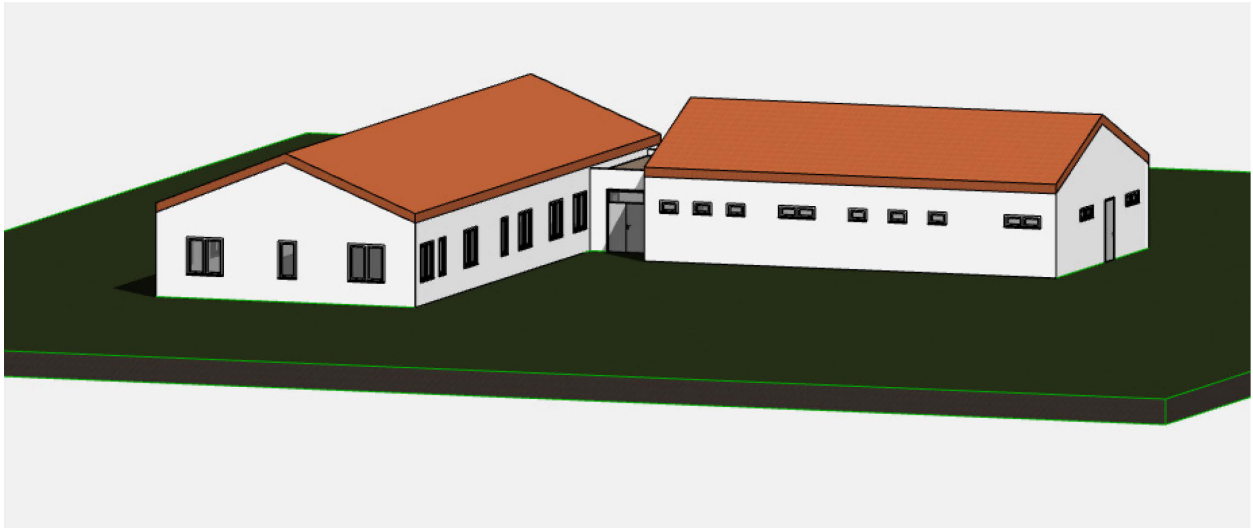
Dienstbürogebäude Dachvariante Satteldach-Satteldach
